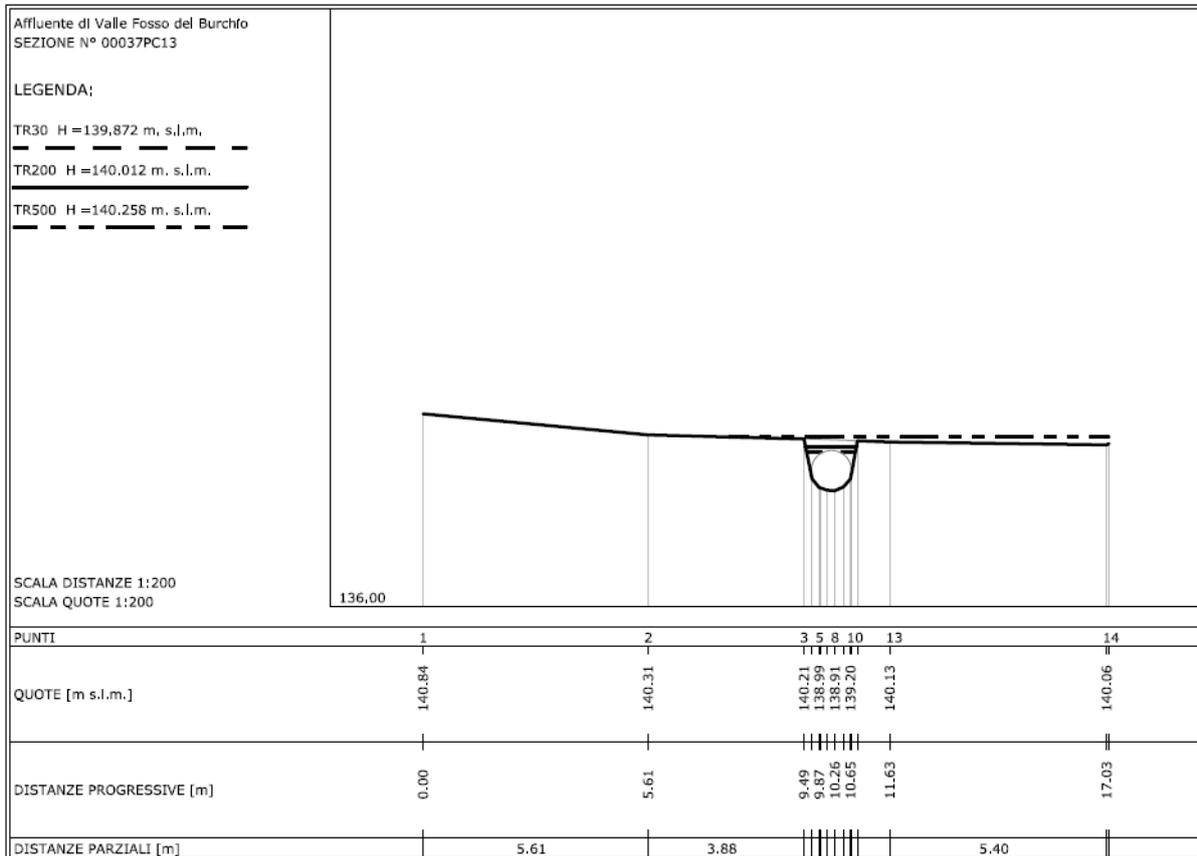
estratto di cartografia di Piano Strutturale “IS1.3_Libretto Sezioni Tr 30_200” – Sezione n. 00037PC13
